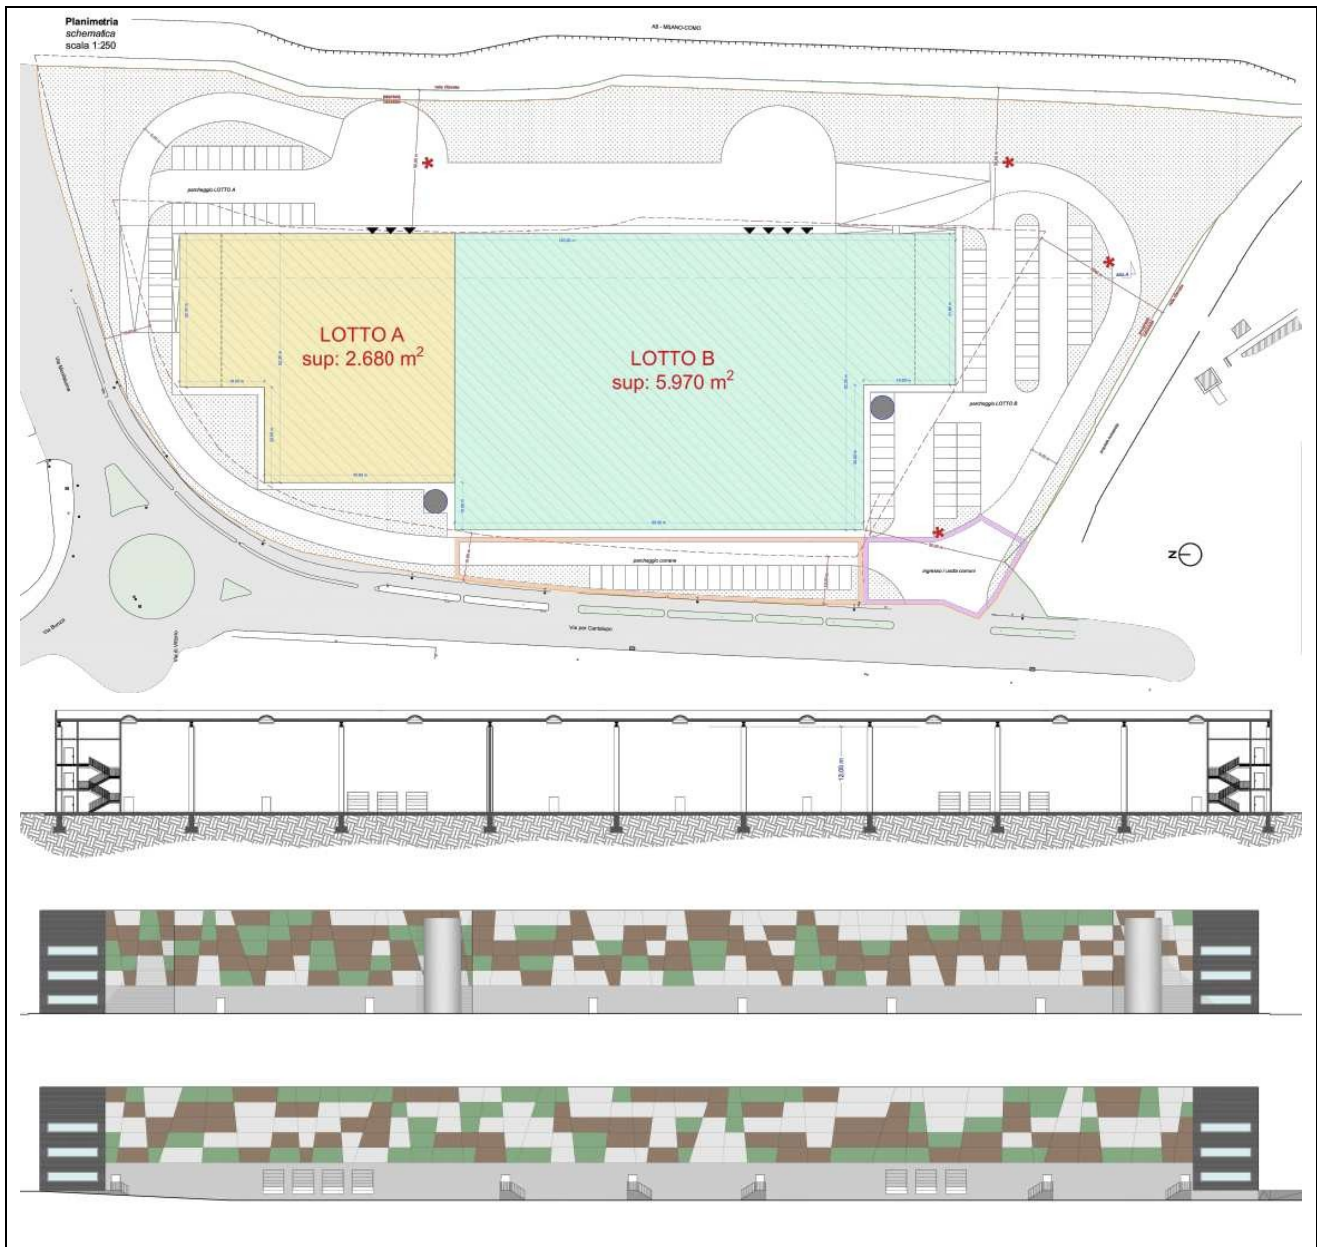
Planimetria , sezioni e prospetto del progetto
